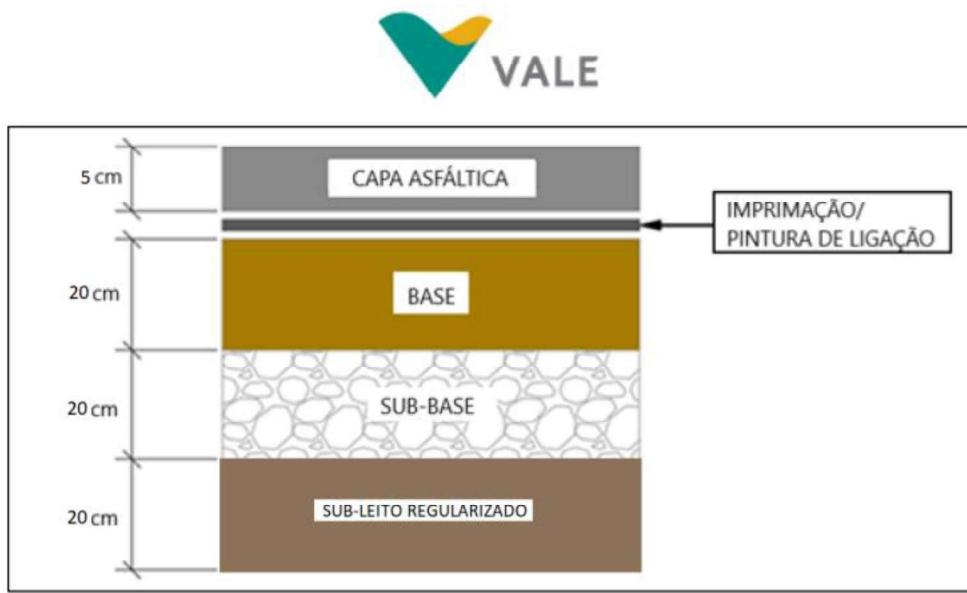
Serviço 1: Pavimento novo com aplicação de CBUQ
